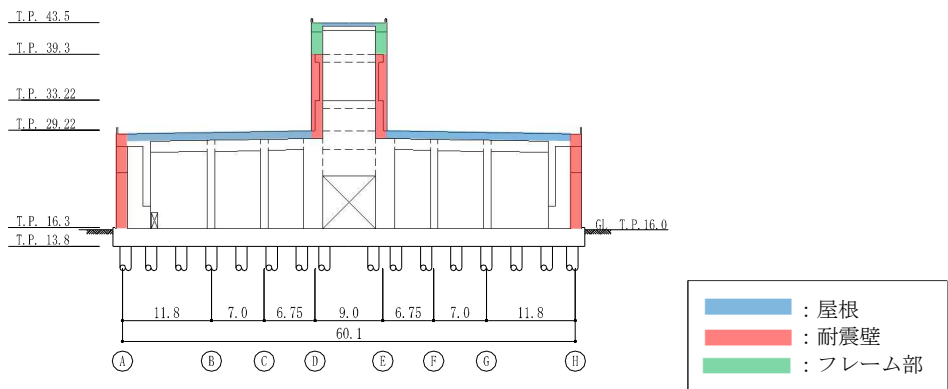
B-B 断面図 (EW 方向) (単位：m)
